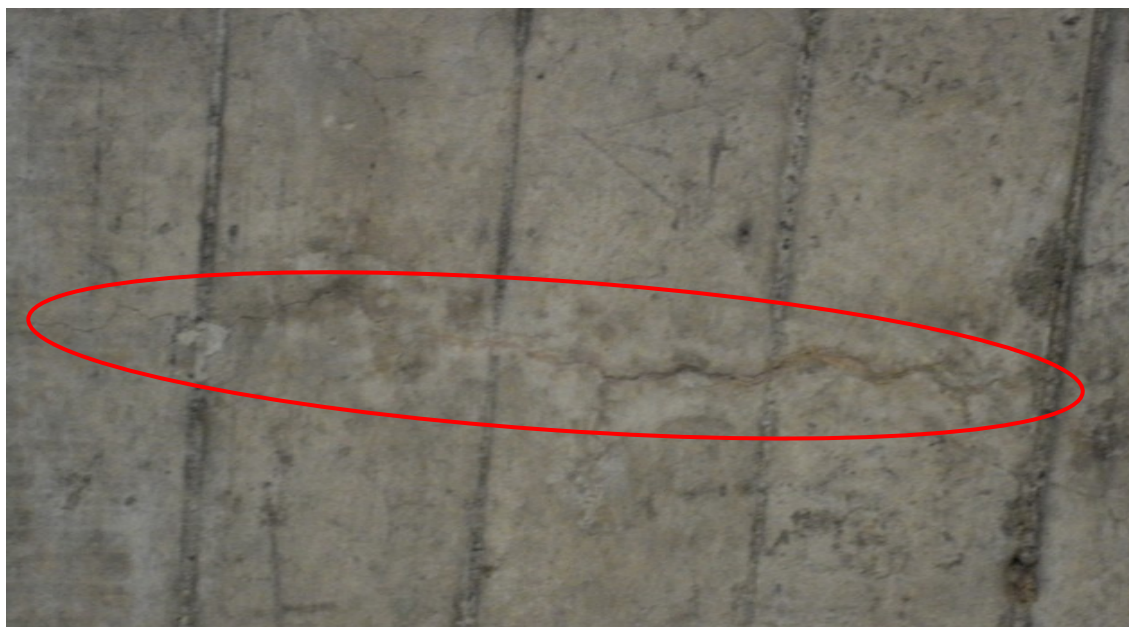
Detalle de grieta en una dirección en la zona inferior de la losa.
